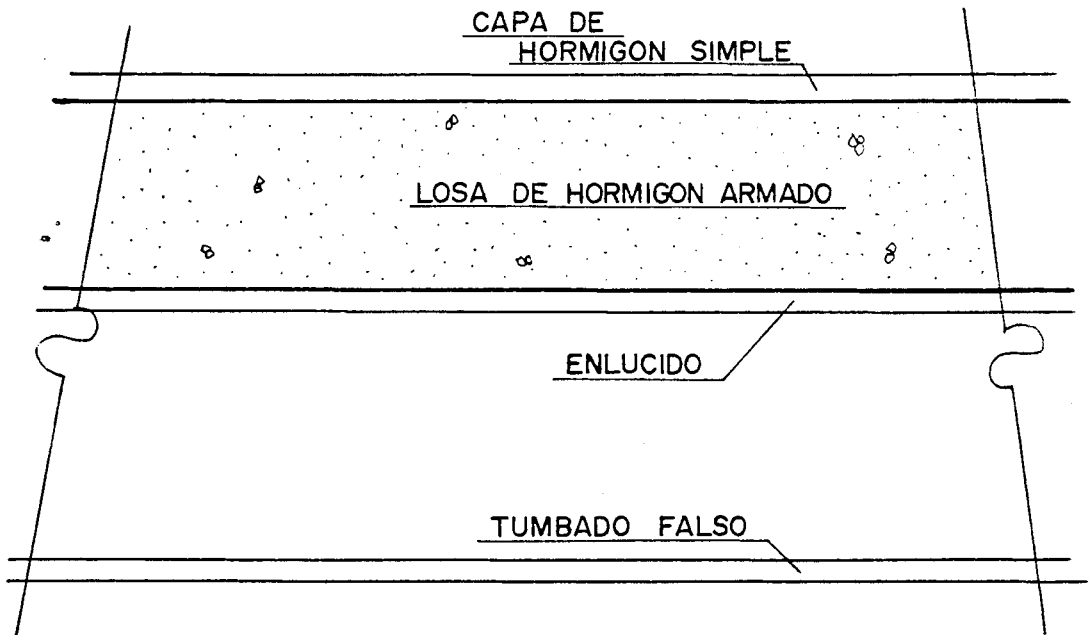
CONSTRUCCION DE TECHO EXTERIOR
